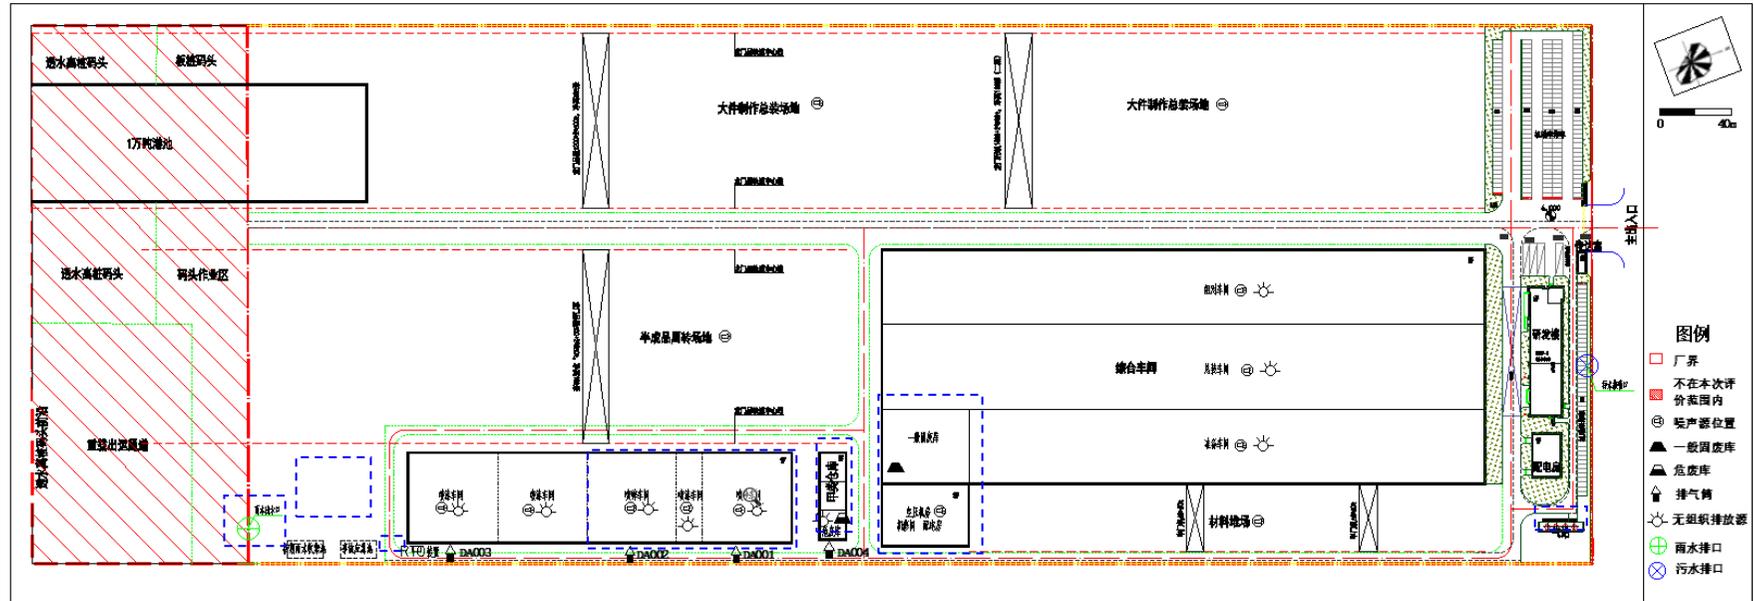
环评中厂区平面布置图（虚线框为变动部分）
